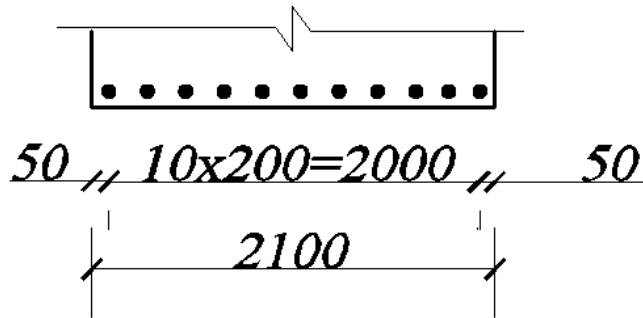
Схема армування плитної частини вздовж більшої сторони
